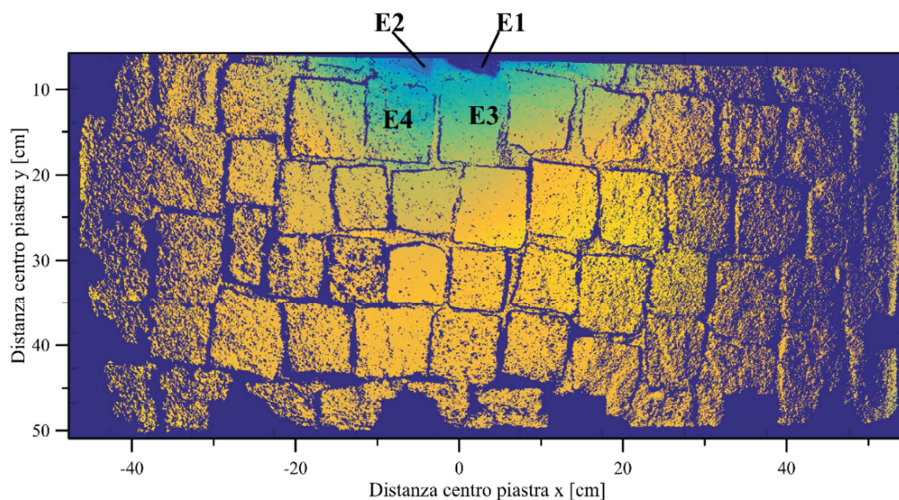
Elementi direttamente caricati dalla piastra E1 ed E2 ed elementi adiacenti E3 ed E4 durante la prova realizzata con pressa dinamica sulla pavimentazione dello Schema 3
